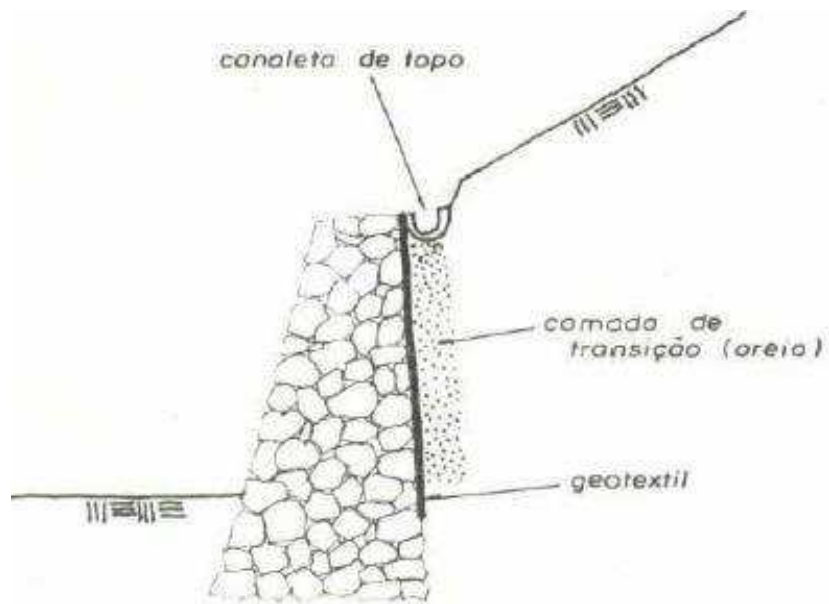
Muro de pedra seca. Fonte: CUNHA (1991).
